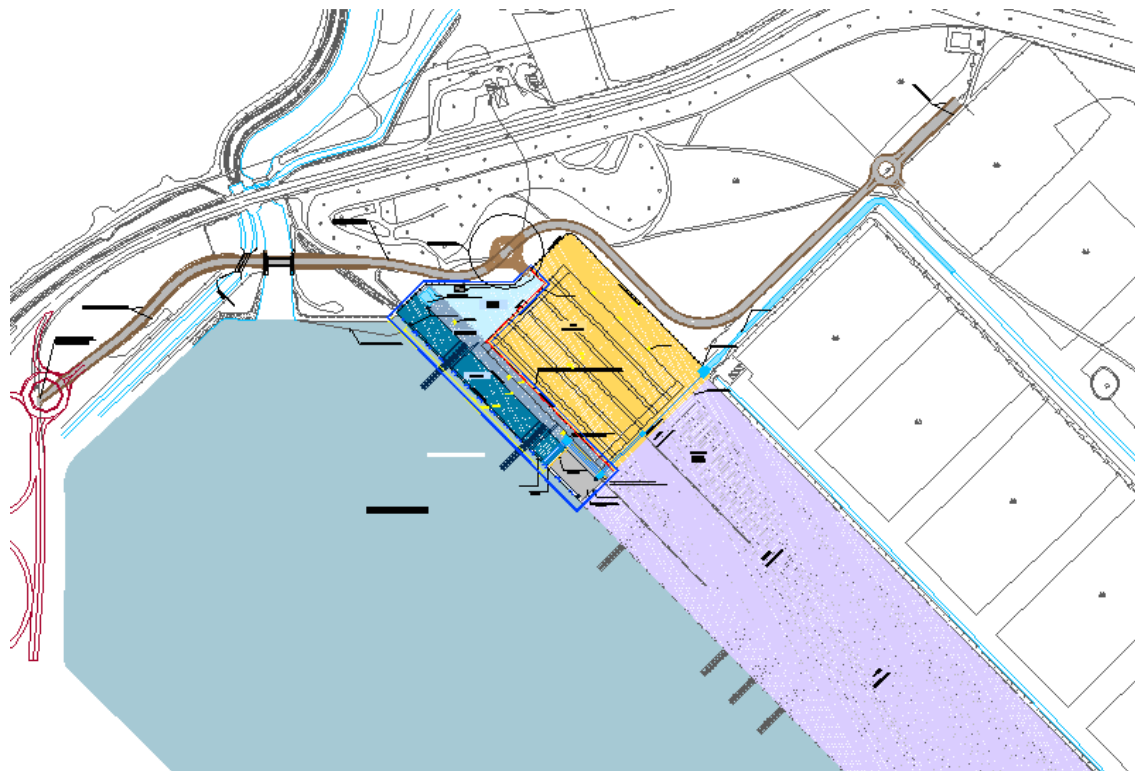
Viabilità di accesso all'area del nuovo banchinamento prevista dal progetto CACIP.
